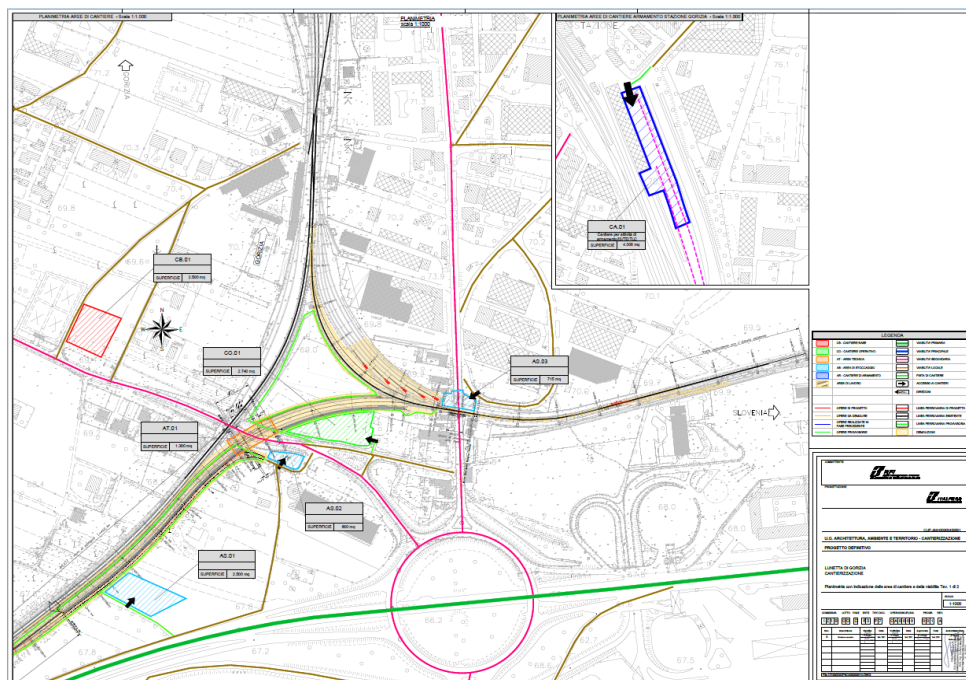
Planimetria con indicazione delle aree di cantiere e della viabilità – Tav.1.
